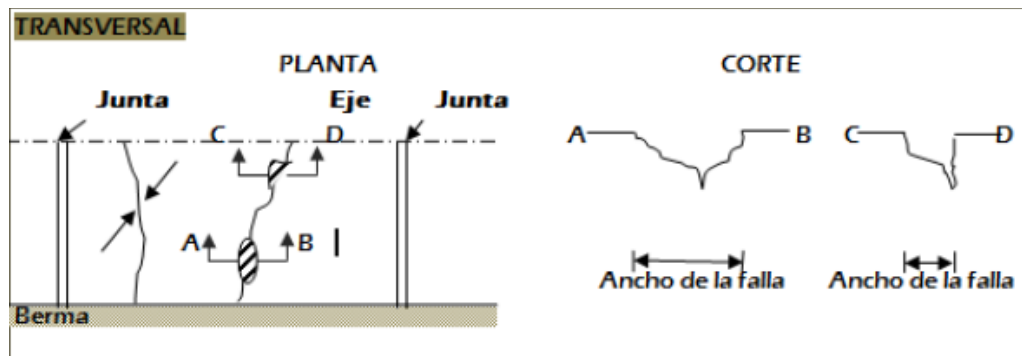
Esquema de la vista en planta y corte de una grieta diagonal en una losa de concreto.
